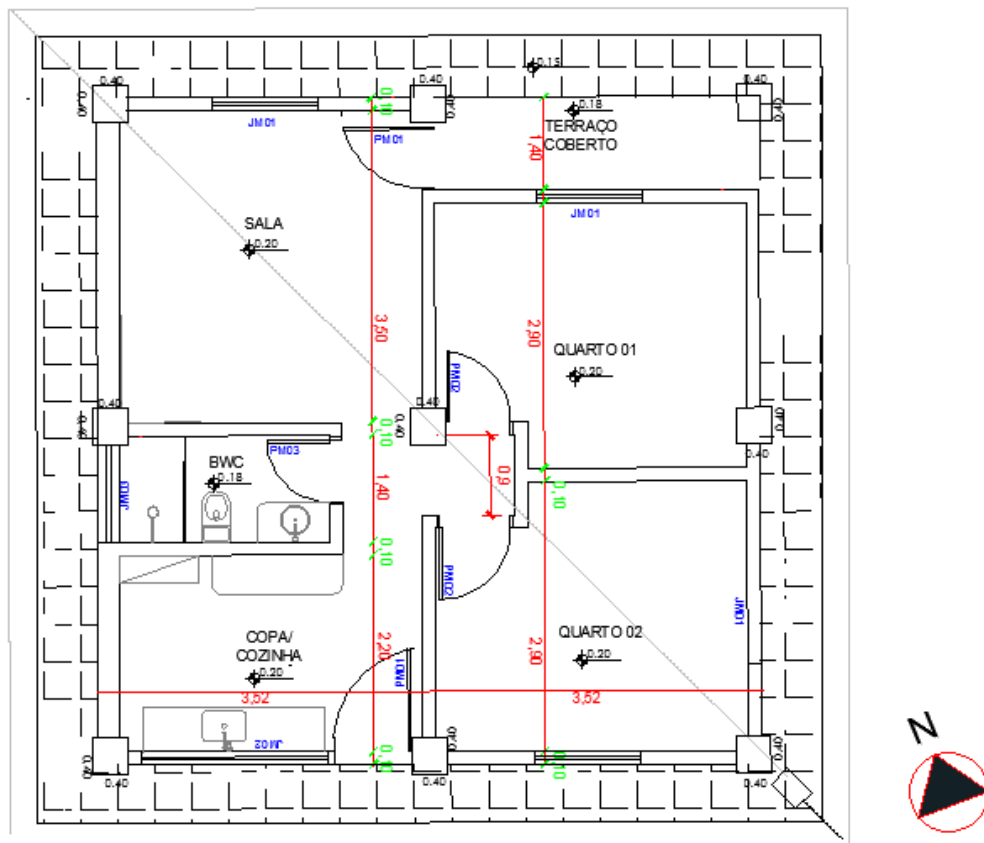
Planta baixa do pavimento térreo da Eco Residência. Fonte: Rocha et al. (2015).
